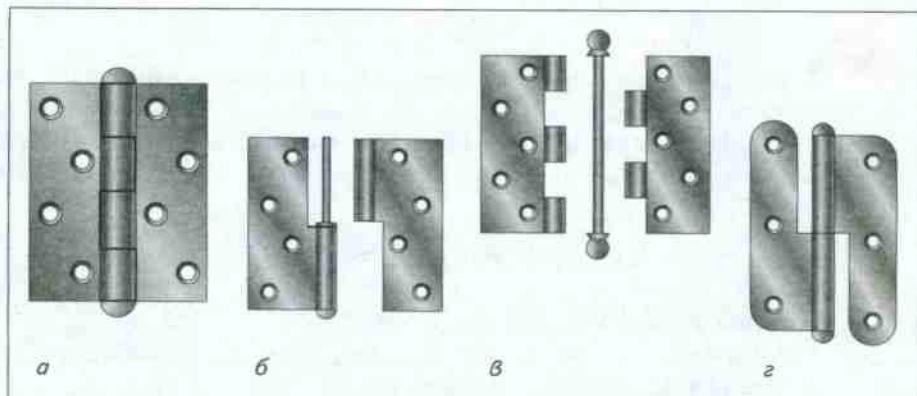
Конструкции петель: *а* — с неразъёмным стержнем,
